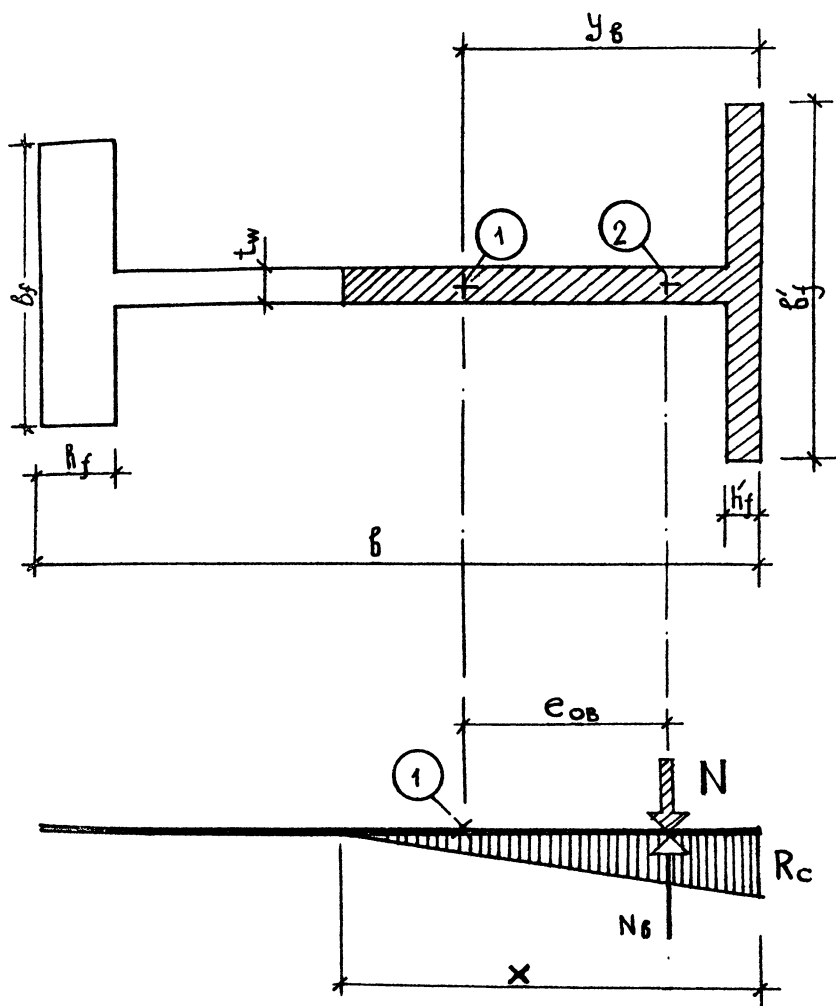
Схема расчета горизонтального сечения несущего стенового элемента при внецентренном сжатии при $e_{ov} \leq 0,95 y_b$:
